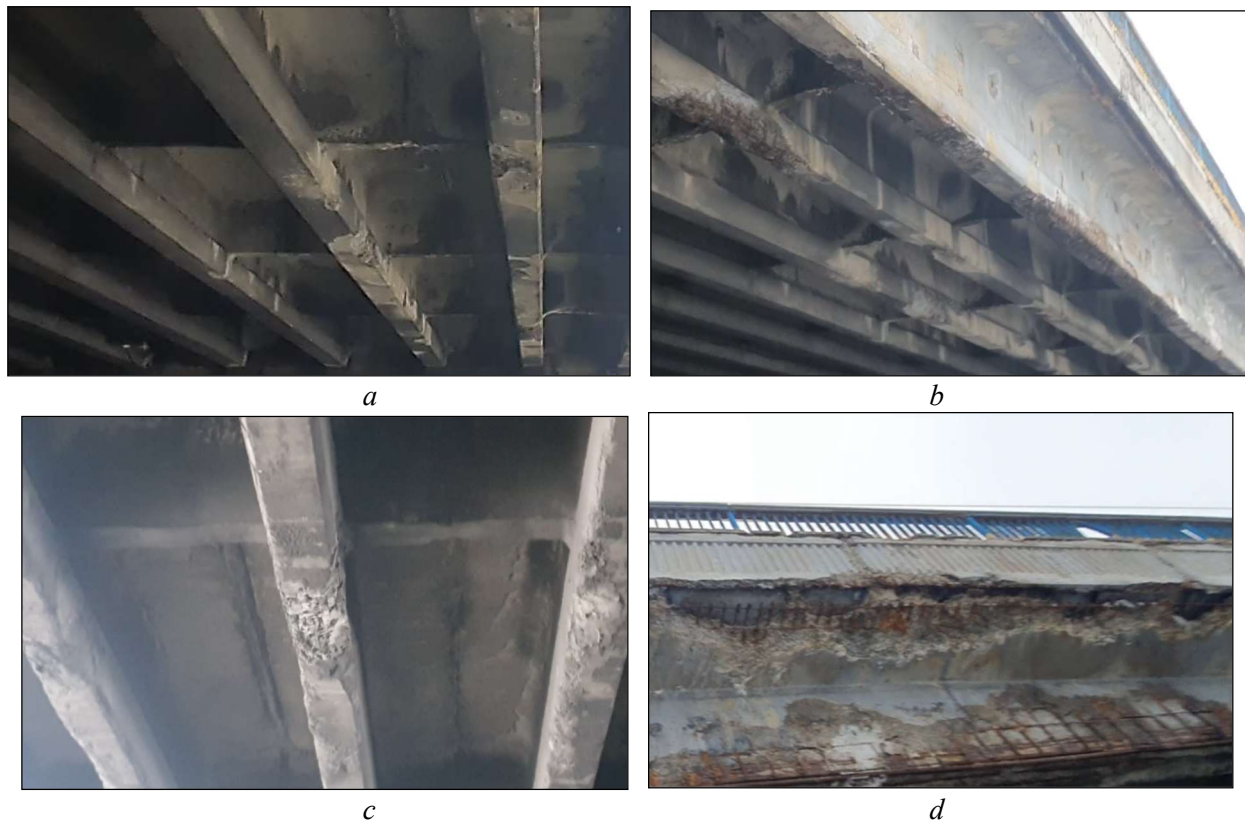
Дефекти балок прогонових будов шляхопроводу: *a* – замокання та вилуговування бетону балок та плити прогонової будови шляхопроводу; *b* – тріщини, сколи бетону з оголенням та корозією арматури балок; *c* – сколи бетону в результаті ударів транспортних засобів з оголенням та деформацією конструктивної арматури балок; *d* – тріщини, сколи бетону з оголенням та корозією арматури, руйнування консолей балок та карнизних блоків прогонової будови шляхопроводу
